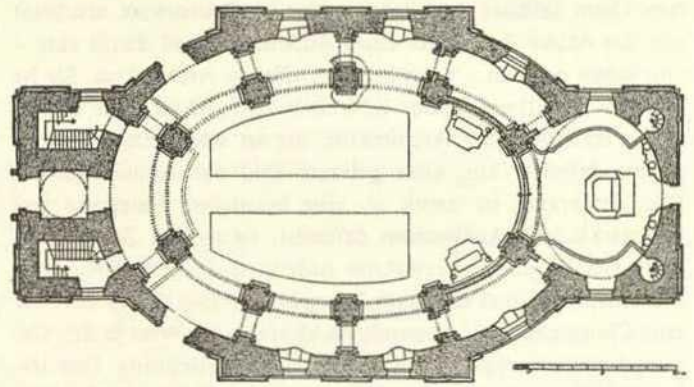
Wallfahrtskirche Steinhausen, Grundriß
